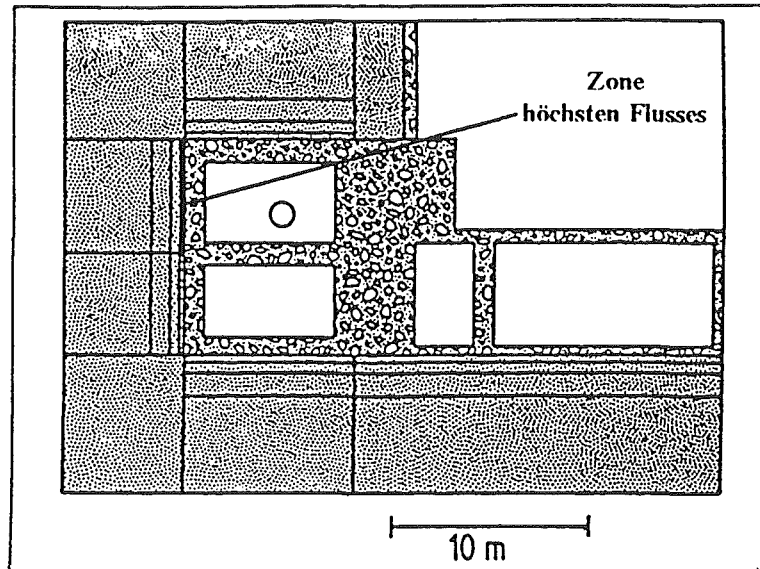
Technisches Layout des Beschleunigertunnels der SNQ /Fil 92/
